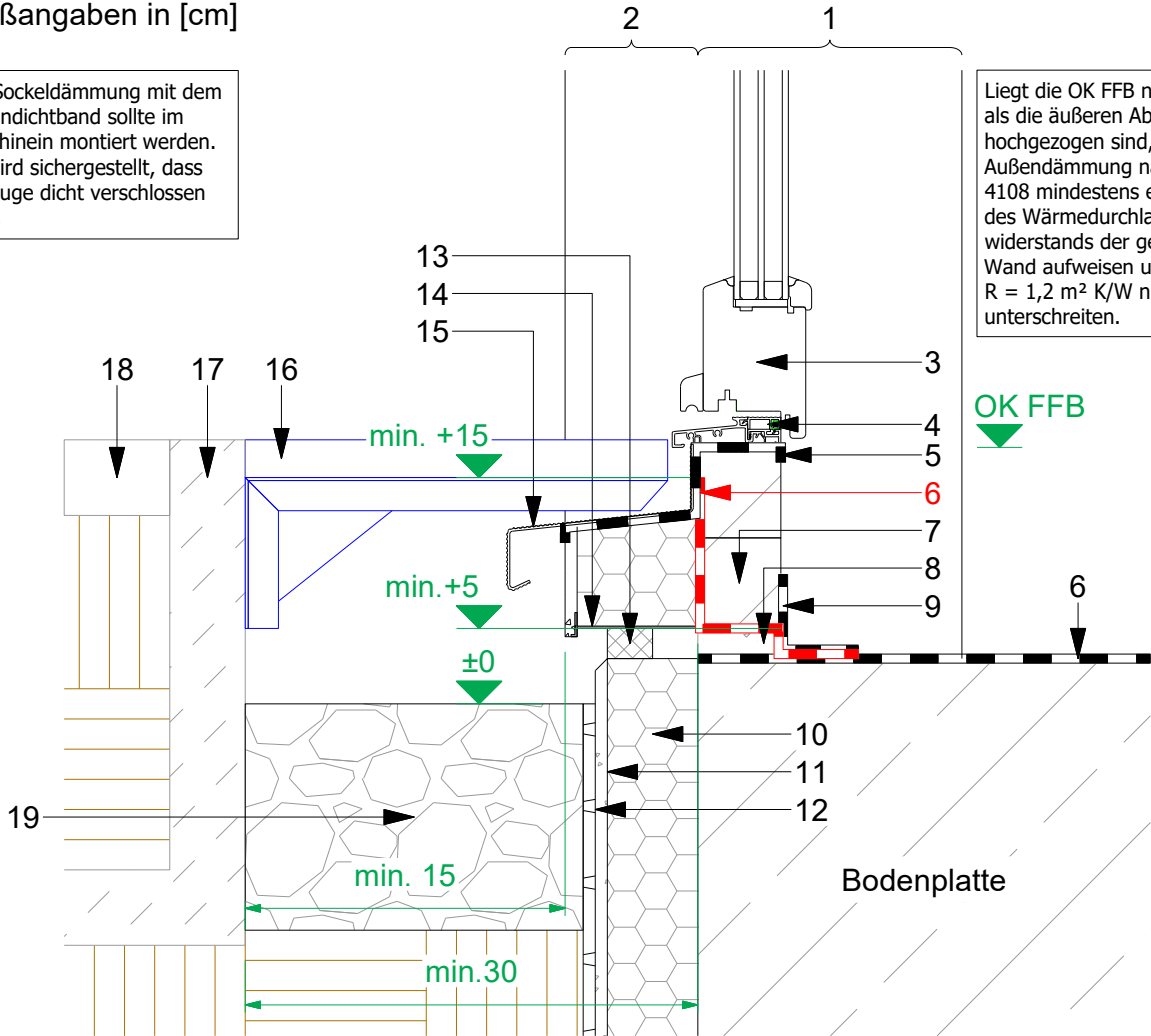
Ebenerdiger Terrassenaustritt mit zweiteiliger Abdichtung nach DIN 18195 und DIN 18533-1 (Empfehlung des DHV)
